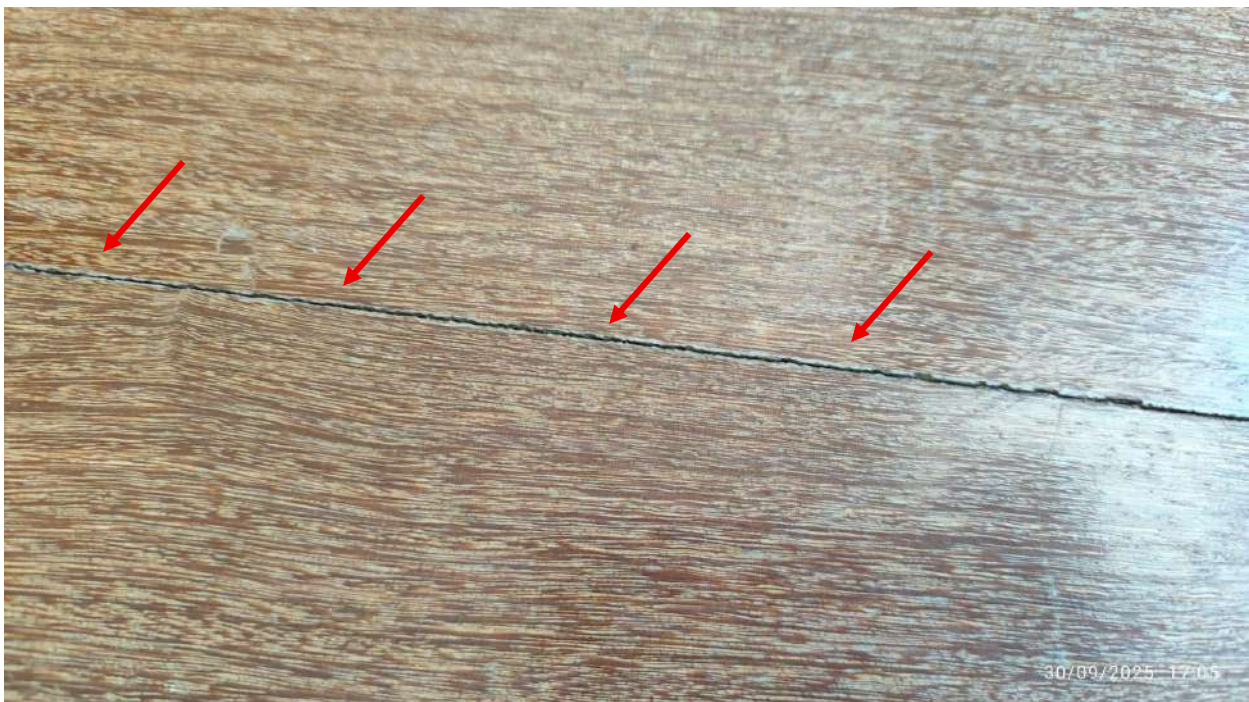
> Notar outro detalhe dos assoalhos, indicando que a água afetou o piso de todo o pavimento superior da residência.
